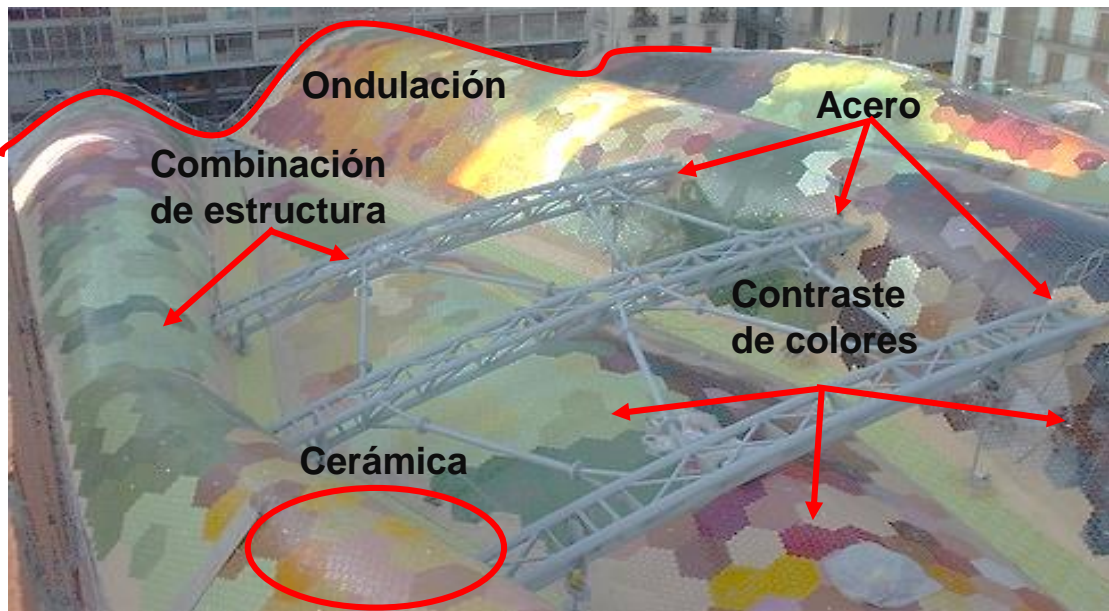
Análisis de la cubierta del mercado Santa Caterina
